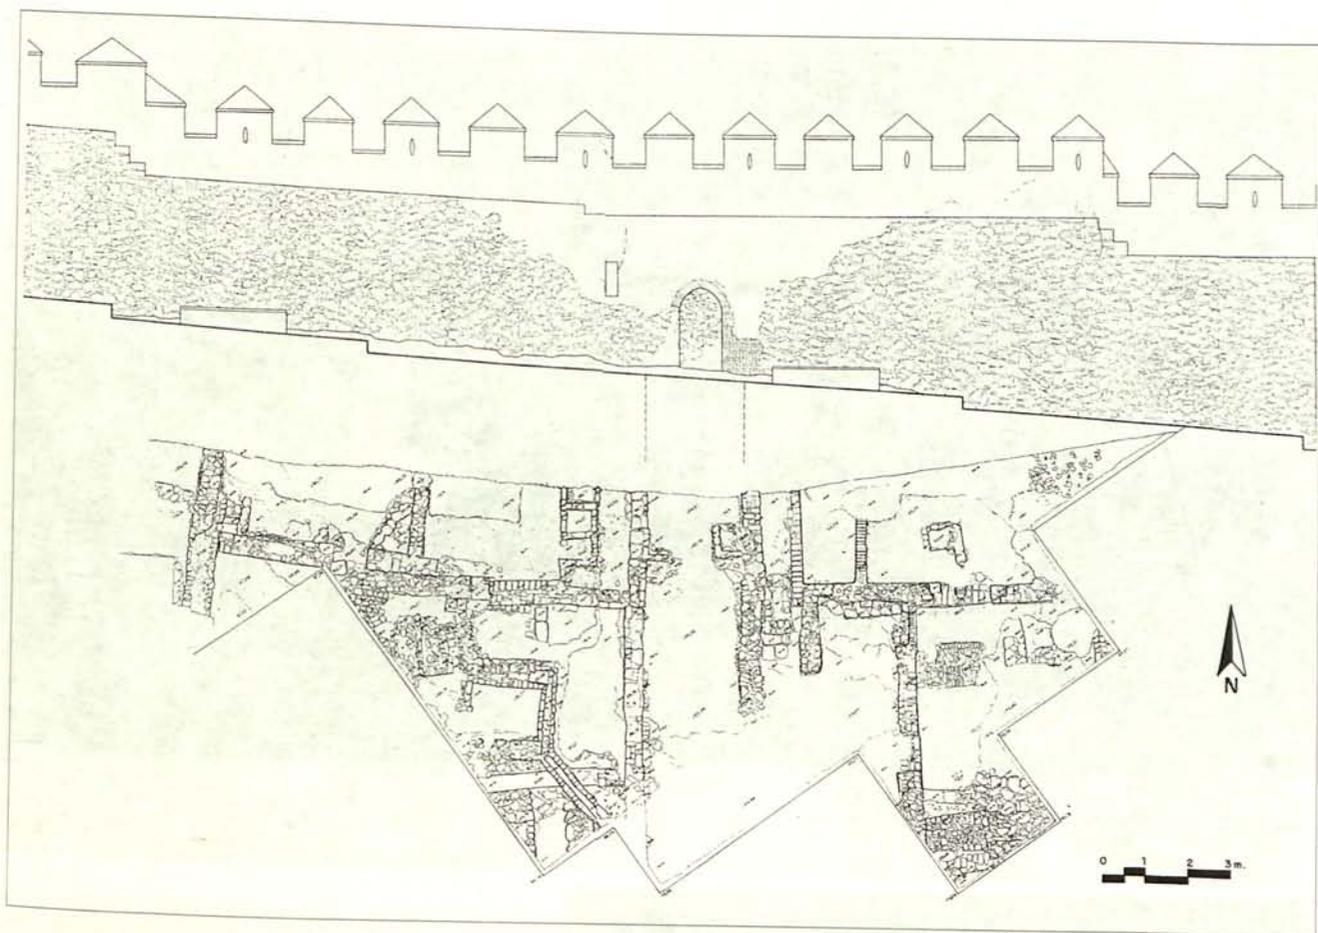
Planta y alzado de la muralla Norte, portillo y viviendas
